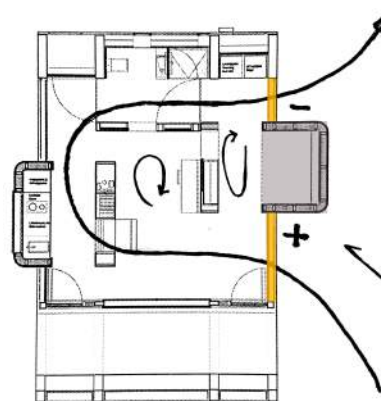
Caso II: aberturas en la misma fachada. Cuerpo sobresaliente.
